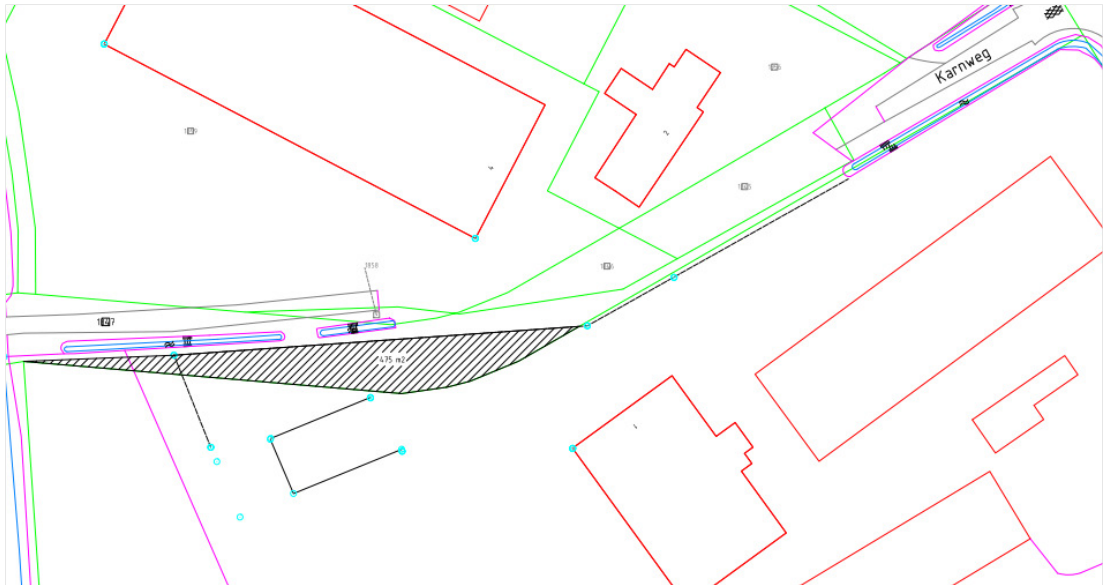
Perceel waarvoor een aanduiding voor zonnepanelen gewenst wordt.
